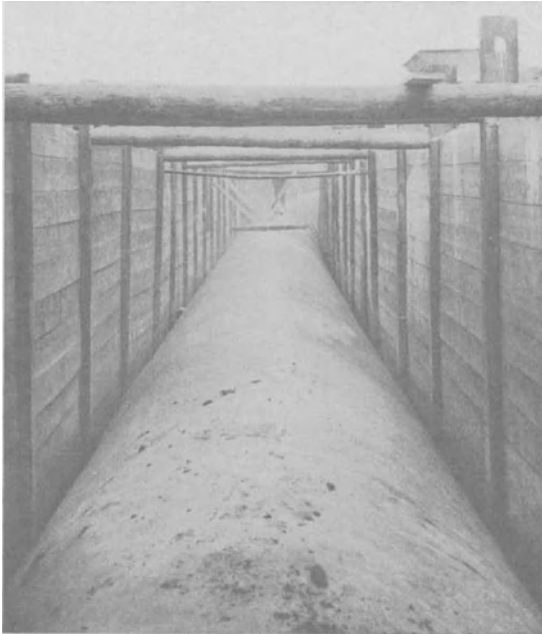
Baugrubenaussteifung mit vertikalen I-Trägern und horizontalen Bohlen.
